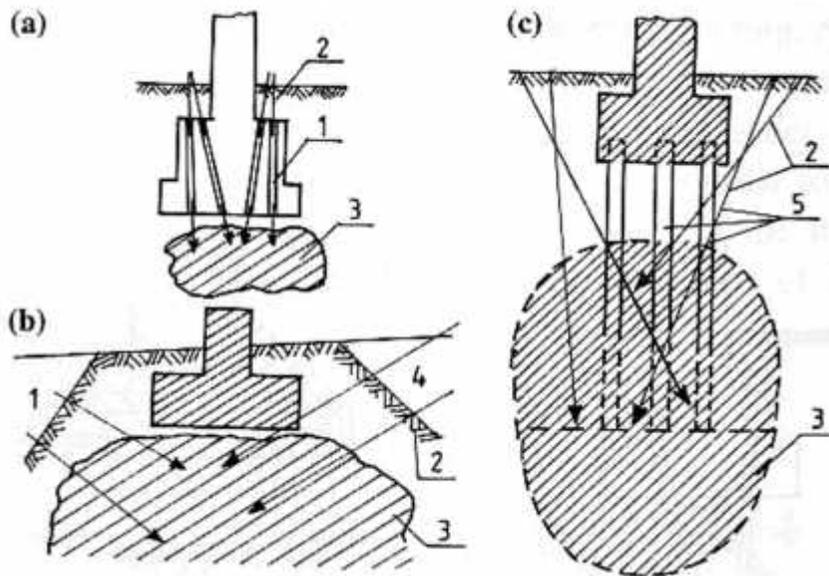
Perkuatan dengan menambah tiang fondasi, a). Perkuatan fondasi langsung, b). Perkuatan fondasi tiang
